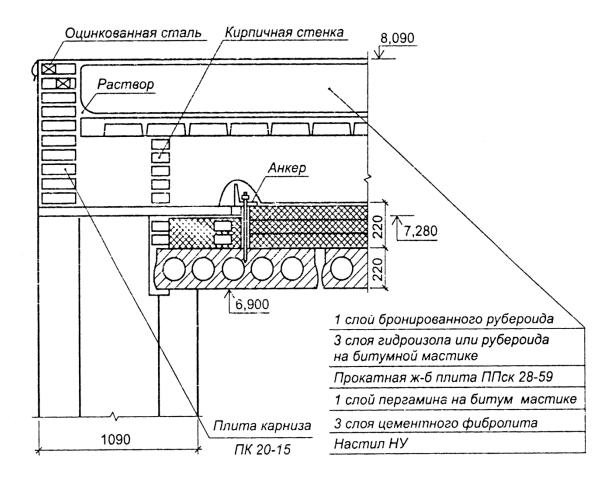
Схема разборки железобетонных плит кровли (сечение 1-1)
